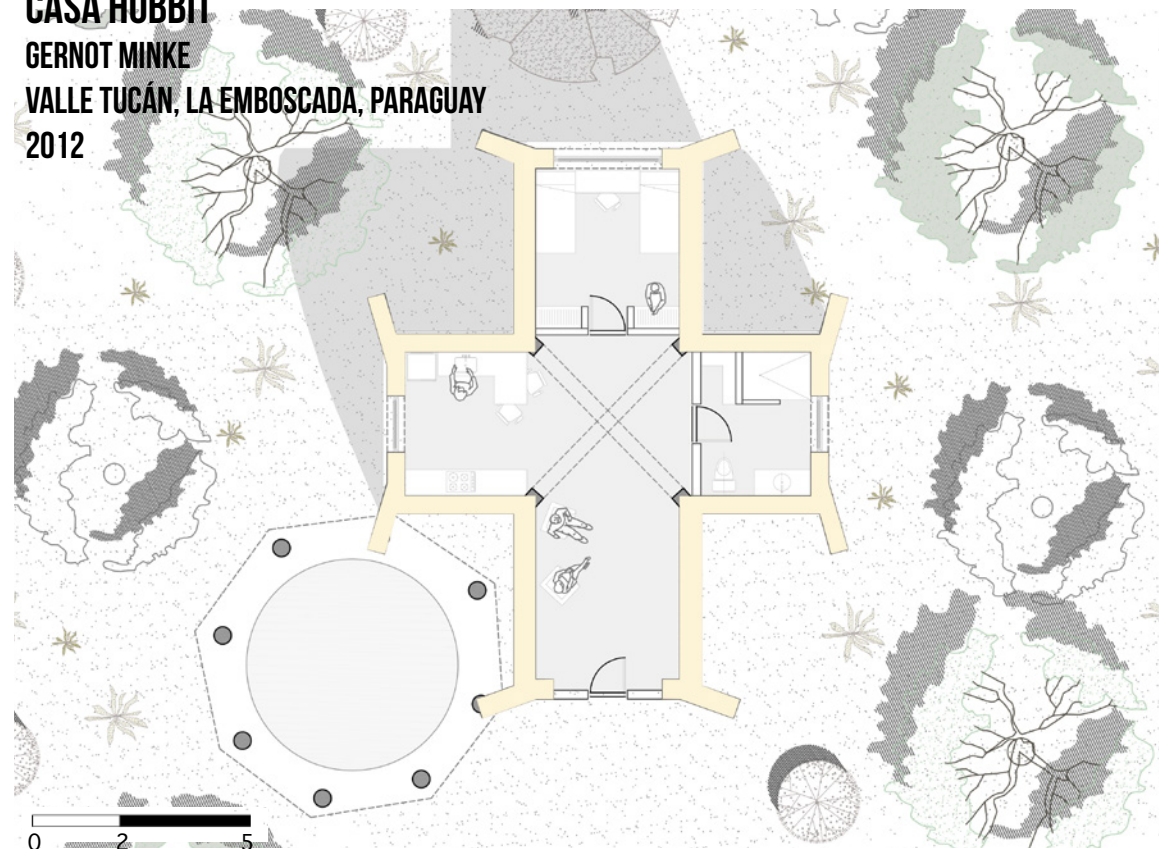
Planimetría redibujada del proyecto. Elaboración propia.
